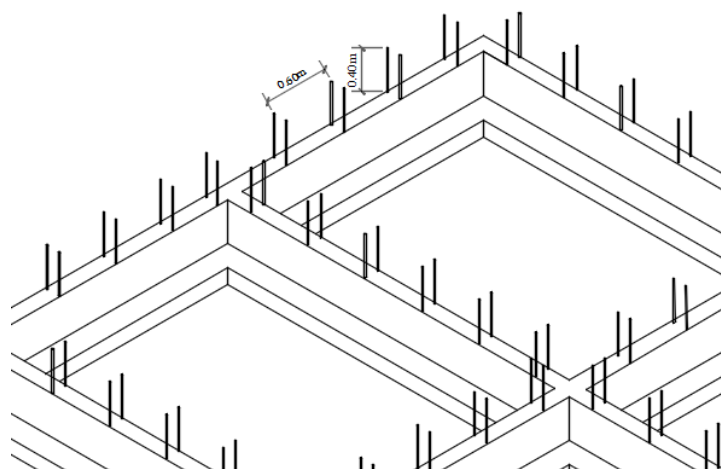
Disposición de las varillas de anclaje para recibir el panel estructural
